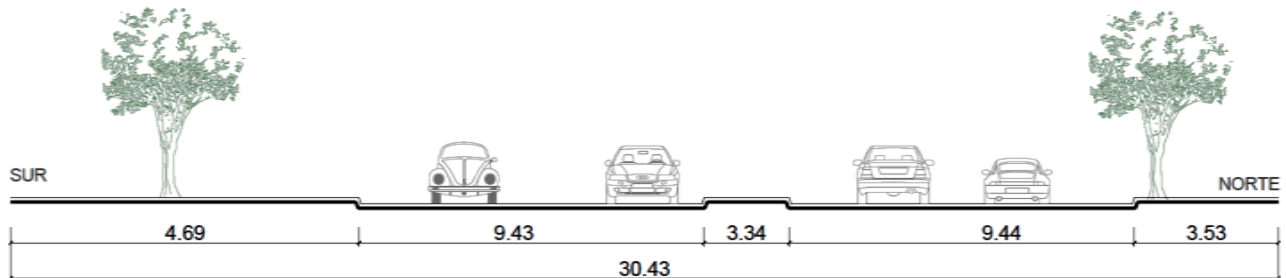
Sección Vial Bulevar 10 de Mayo cruce con calle Santos Degollado
